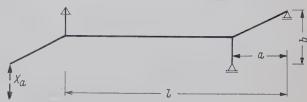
Statisch bestimmtes Hauptsystem eines schiefen Hohlkastens
